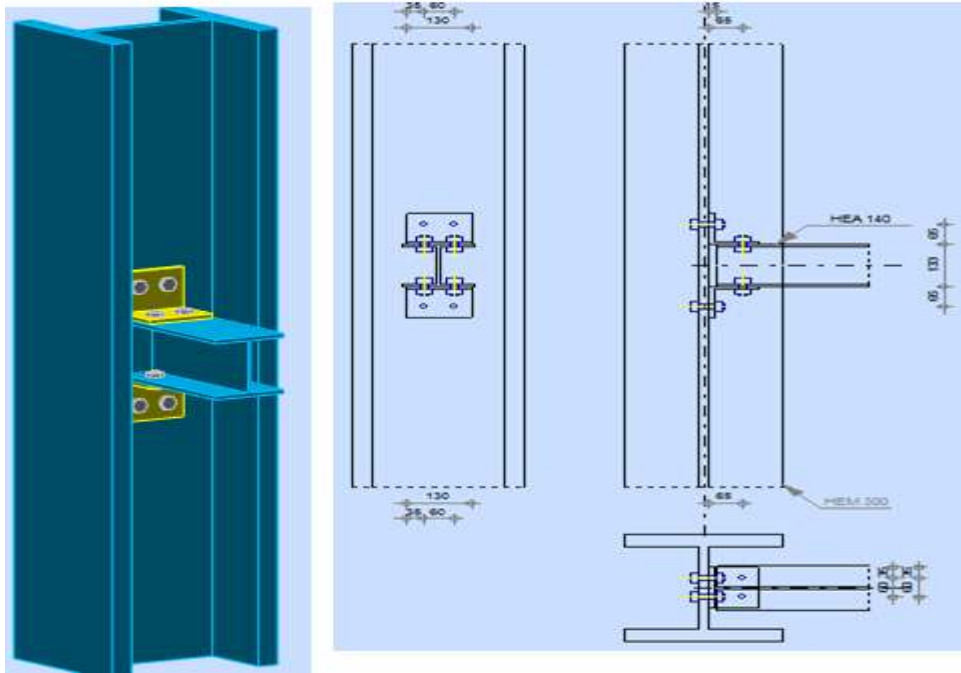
Représentation de l'assemblage poteau HEM 300 – sablière HEA 140
